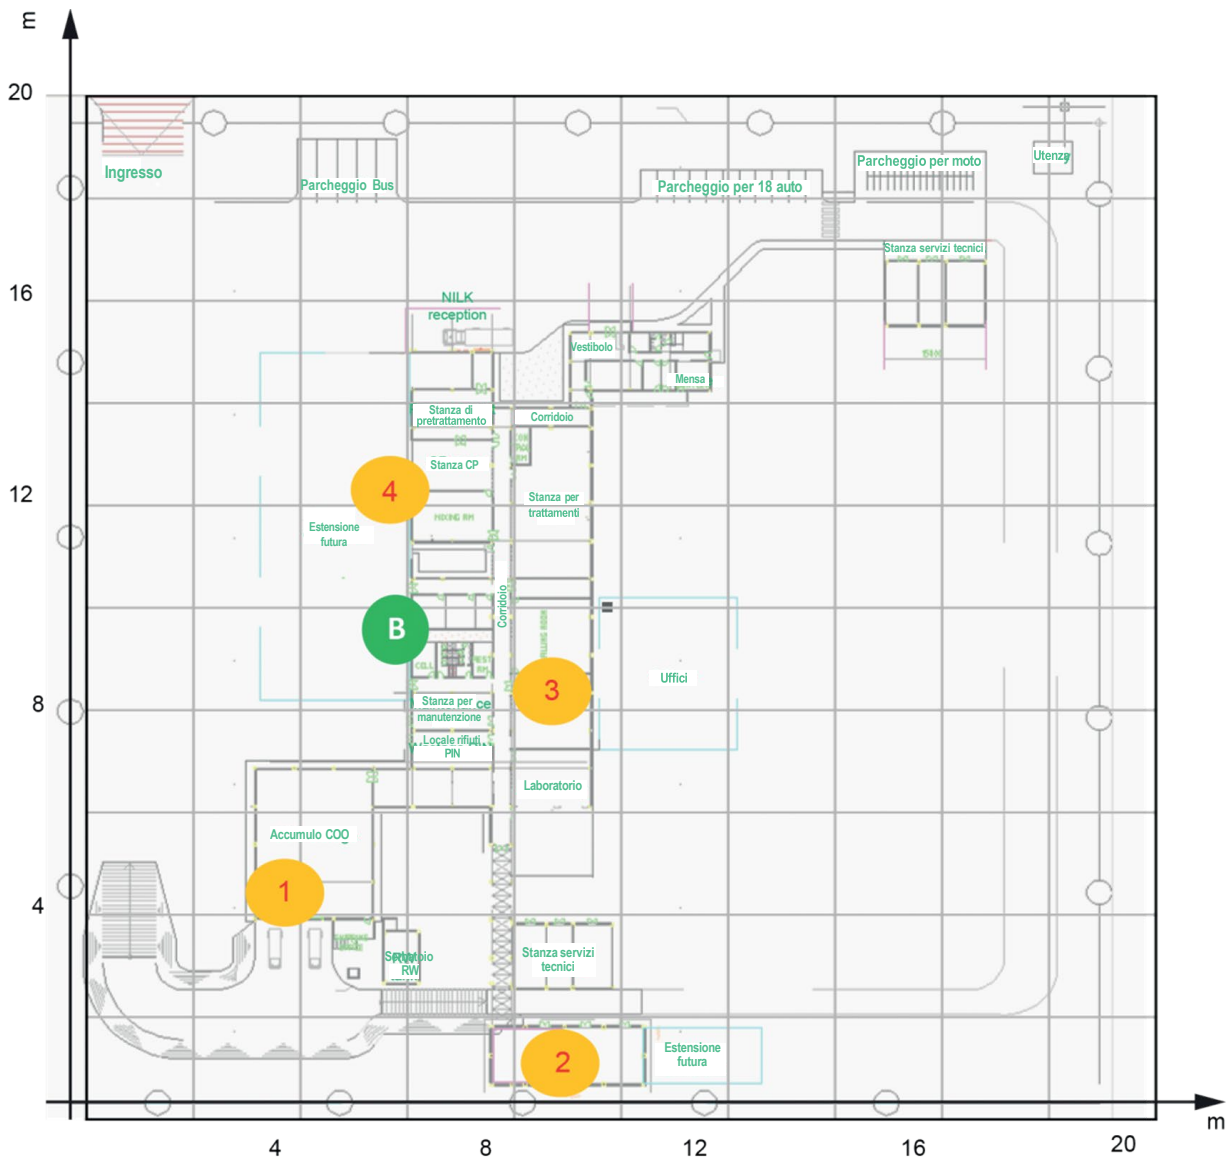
Esempio 1: Pianta dell'impianto di produzione con i carichi previsti e il baricentro calcolato
